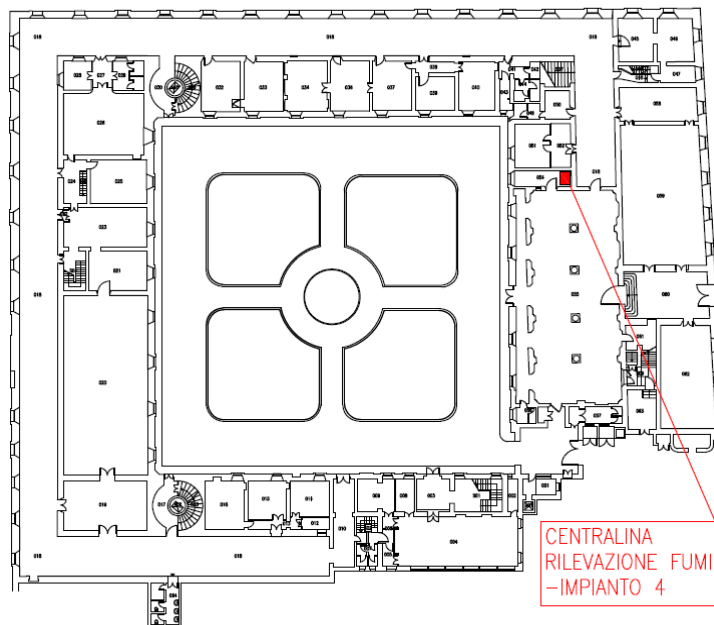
d. Planimetria impianti gestione emergenze – IMPIANTO 4.
